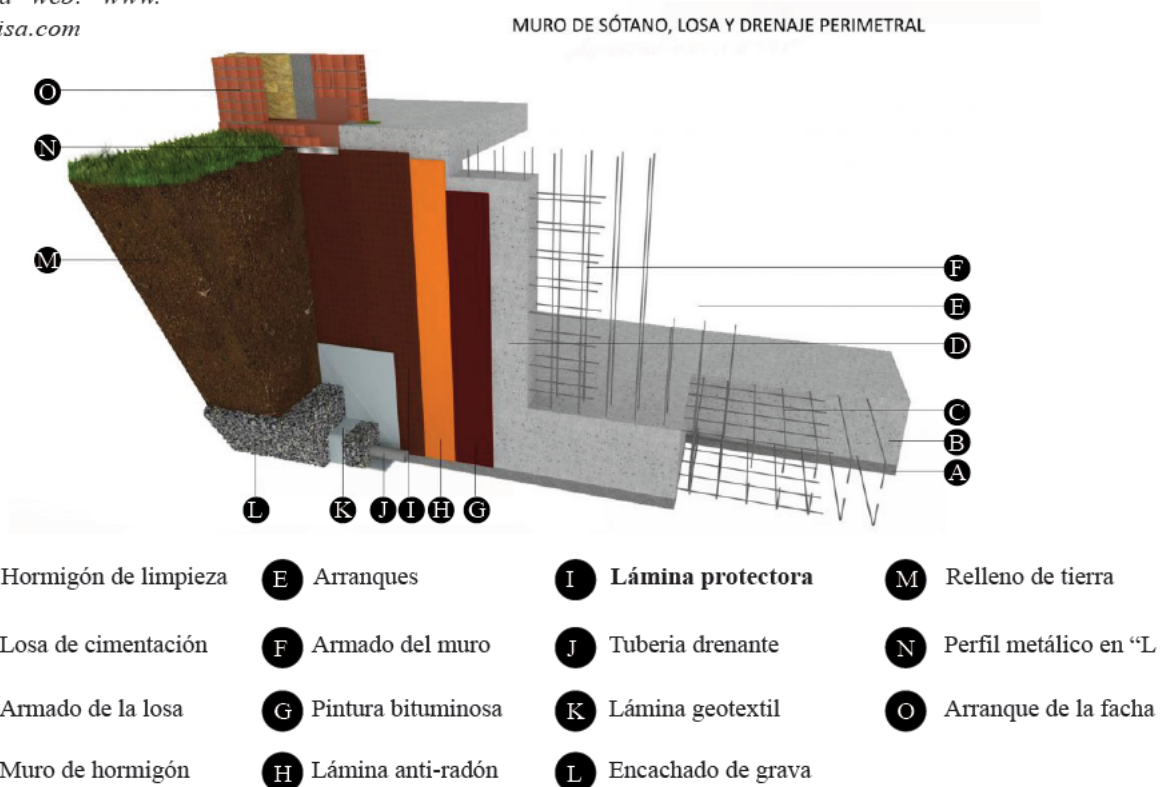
Detalle constructivo de lámina anti-radón en edificación con sótano.
